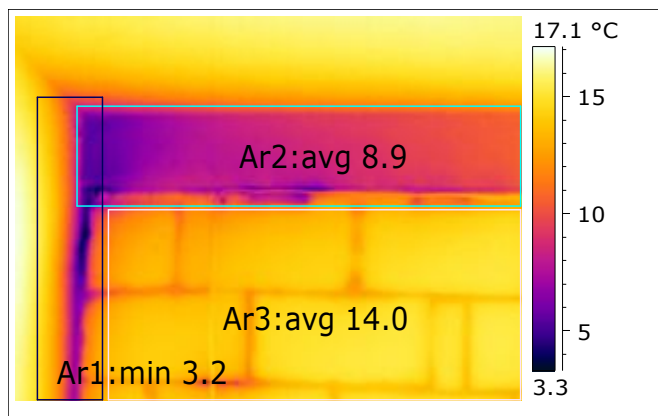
Локальные нарушения технологии исполнения узлов стыков и примыканий конструкций стены, приводящие к нарушению санитарно-гигиенических требований безопасности жилища
